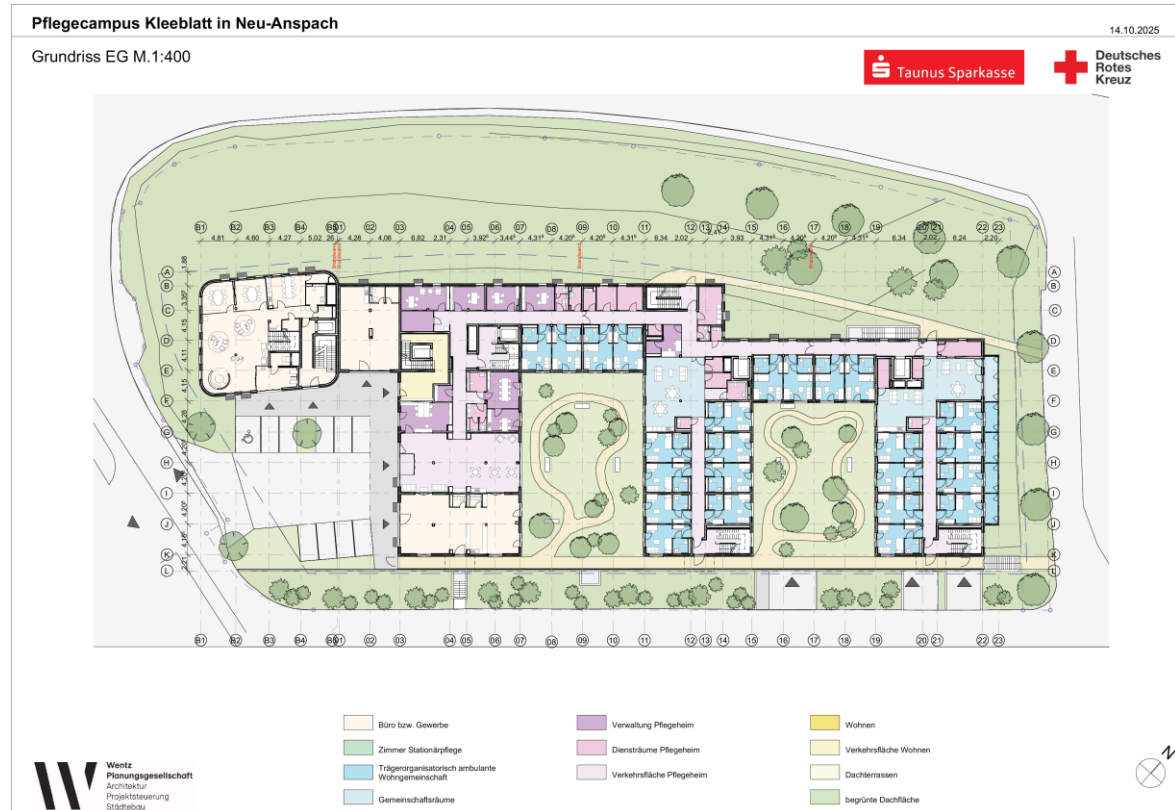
Grundriss EG, unmaßstäblich
